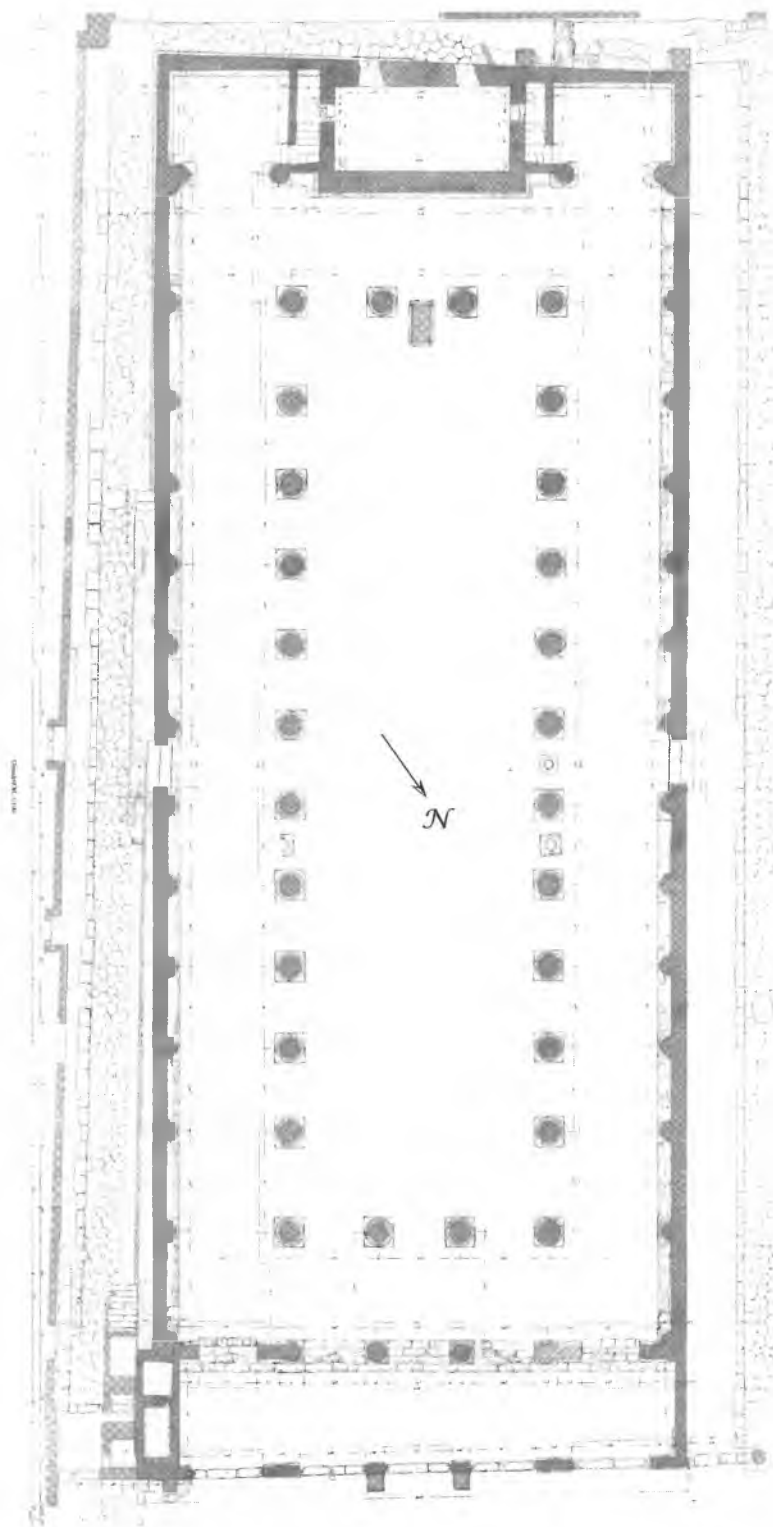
Pompeji, Basilika, Grundriss. Nach Ohr aO. Taf. 38.
